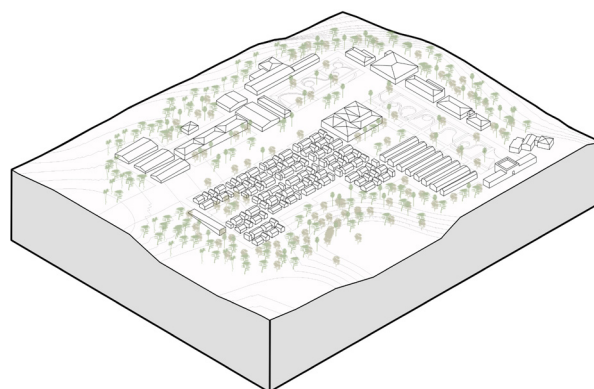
Axonometria do desenho urbano proposto na Roça Sundy|
